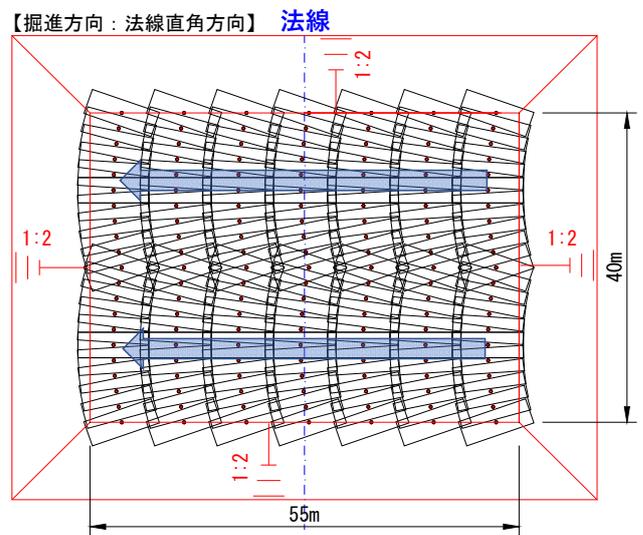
底面部掘進（法線直角方向）イメージ平面図
